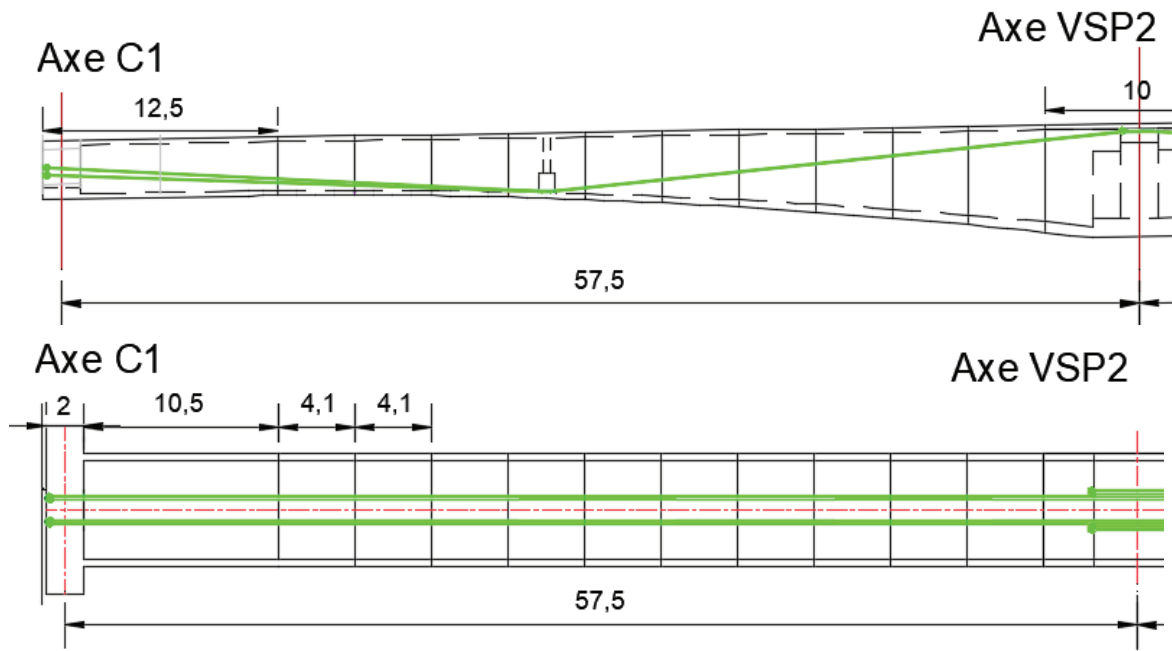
Tracé en élévation et en plan des câbles extérieurs de travée de rive.
